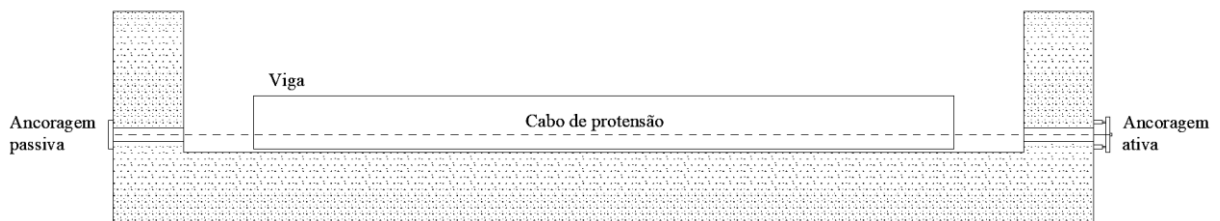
Sistema de pré-tração de vigas pré-moldadas
